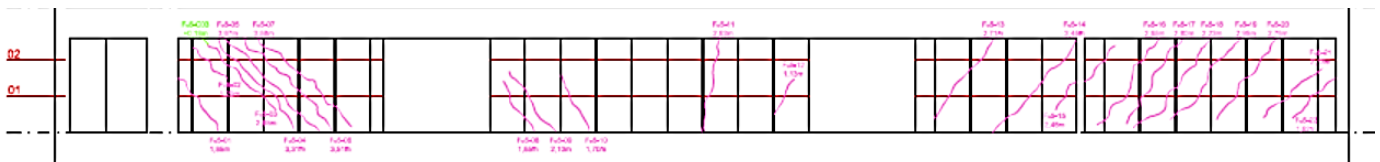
Levantamiento de fisuras en muro interior de 35 cm de espesor a fecha de 11/02/2013 (AICEQUIP, (2013)).
